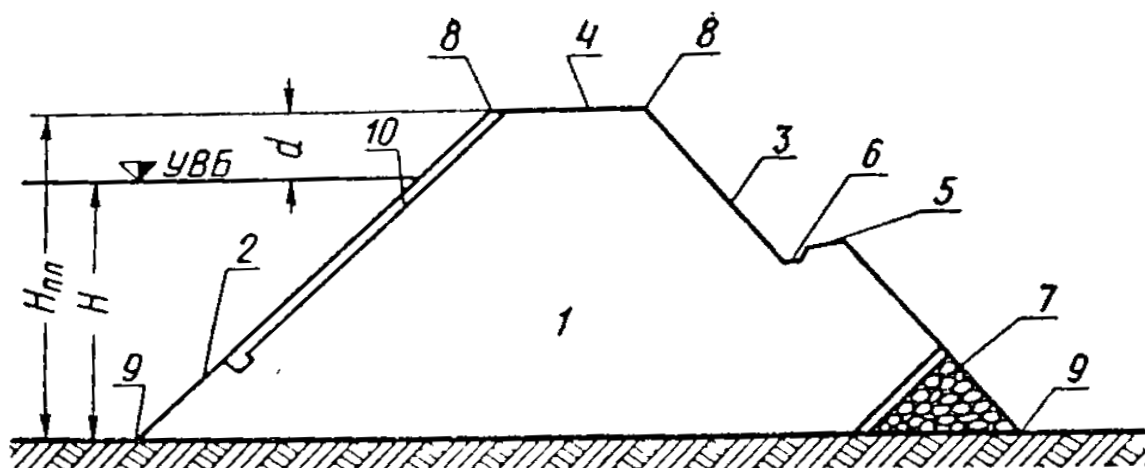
Элементы профиля земляной плотины: 1 – тело плотины; 2 – верховой откос; 3 – низовой откос; 4 – гребень плотины; 5 – берма; 6 – кювет; 7 – дренажная призма; 8 – бровки; 9 – подошва откоса; 10 – крепление откоса
